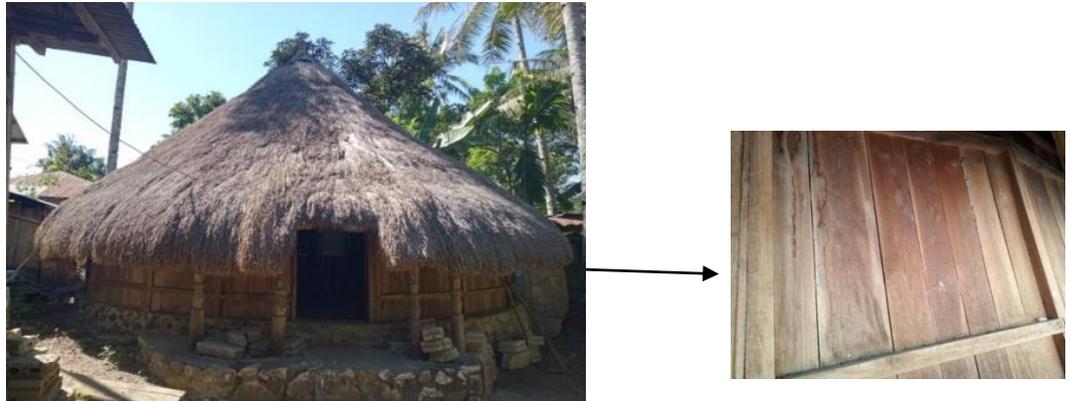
Fondasi Rumah Adat Taunim Kuabib
